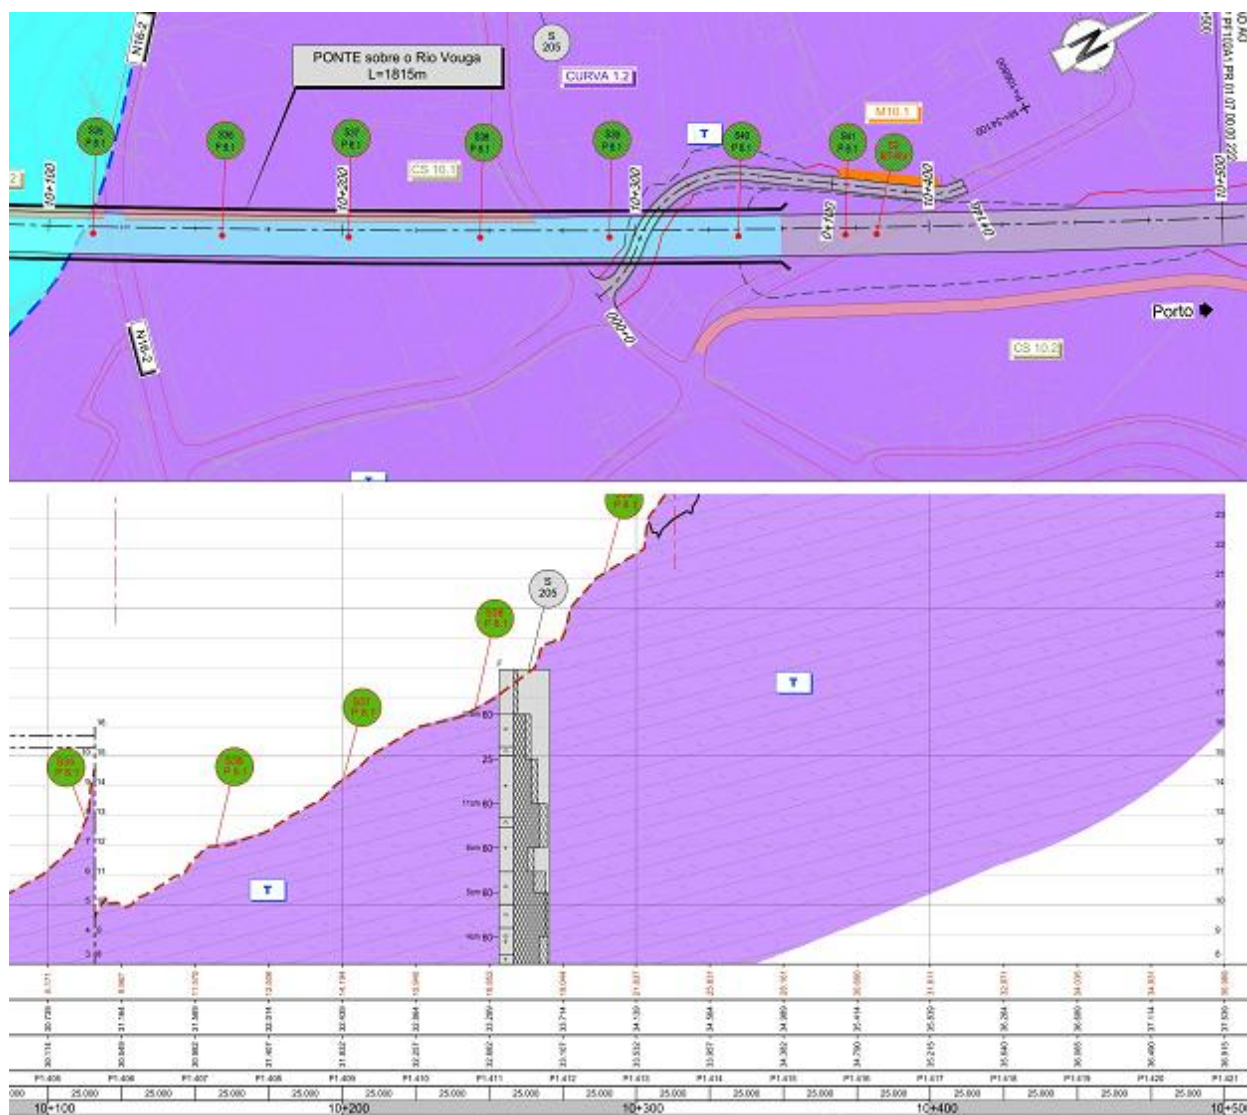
Muro M10.1. Planta e corte geotécnico. Extrato do Des. PF102A1.PR.01.07.00.00.121.00
